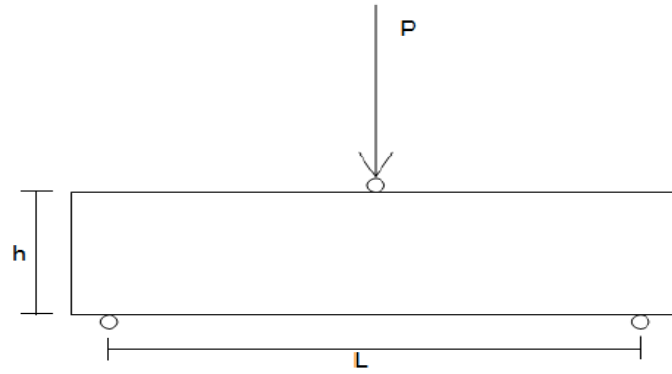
Modelo para ensayo flexión en vigas de mortero.
